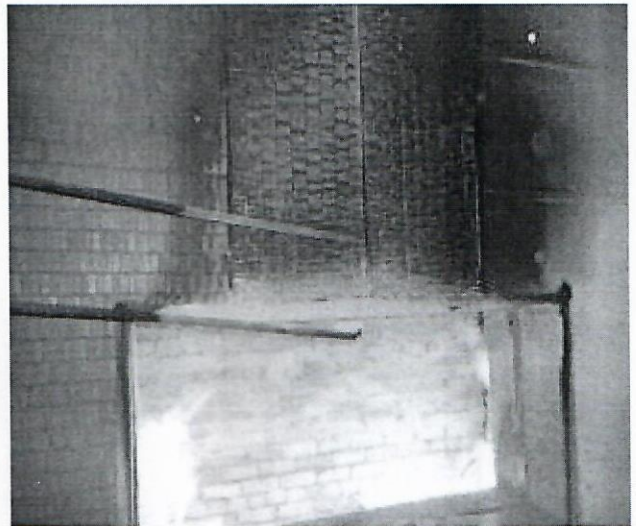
Фрагменты образца фасада после испытания по ГОСТ 31251-2008.
